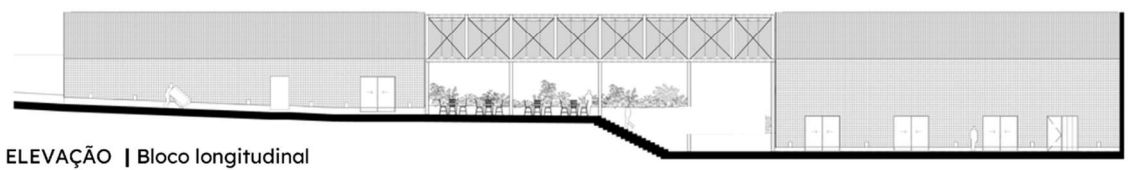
Plantas, cortes e fachadas | Fonte: Archdaily adaptado pela autora
